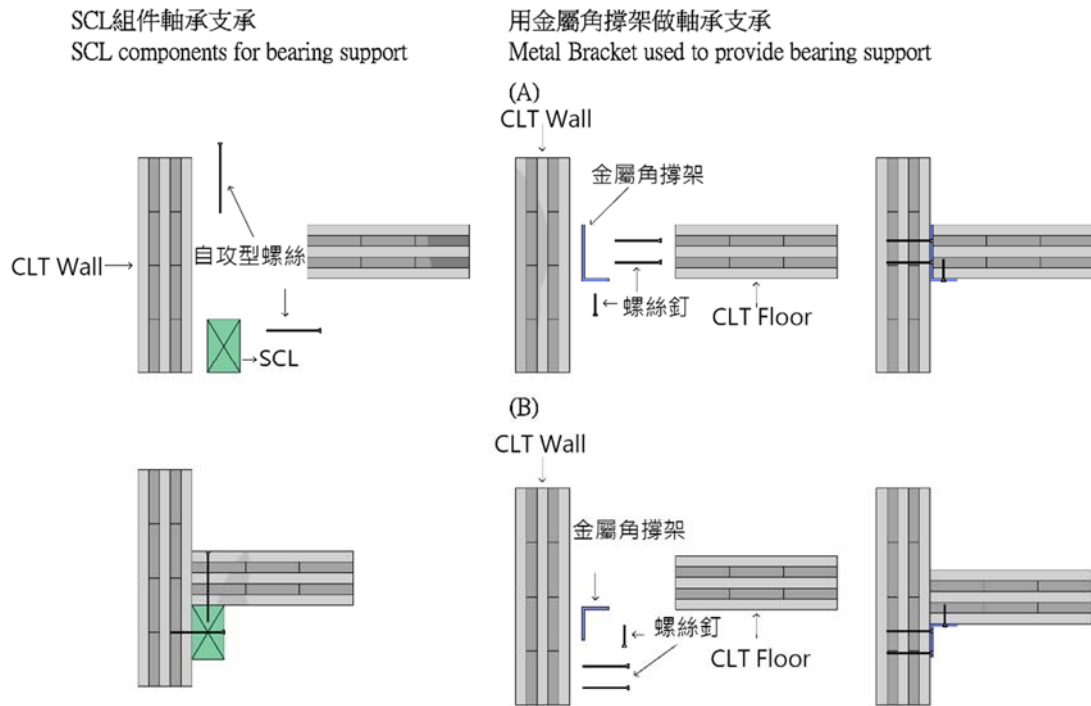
(b) Wall to Floor(Ballon System)主要接合形式
